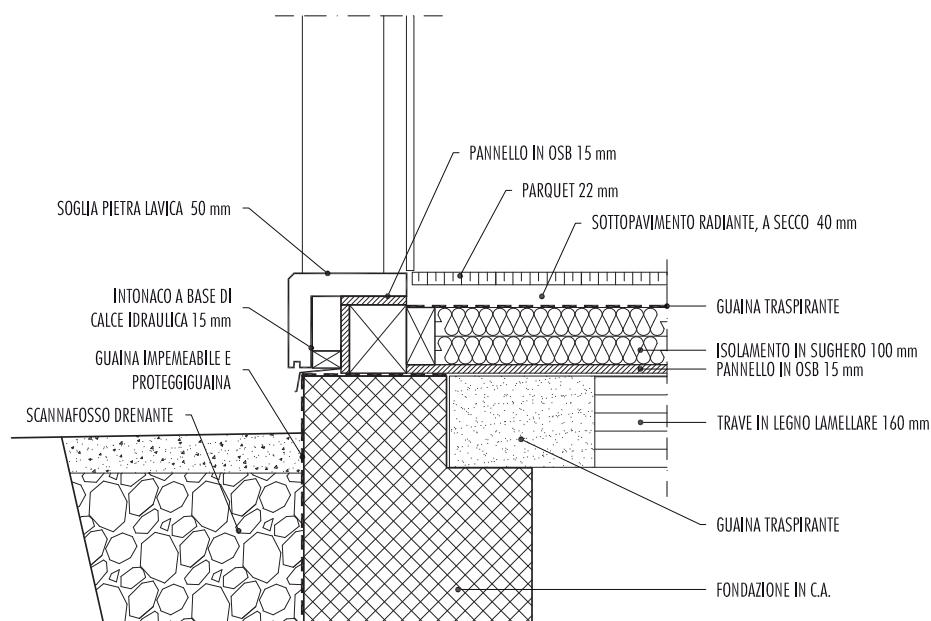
\_Dettaglio fondazione. Giunto fondazione-soglia-infisso.
